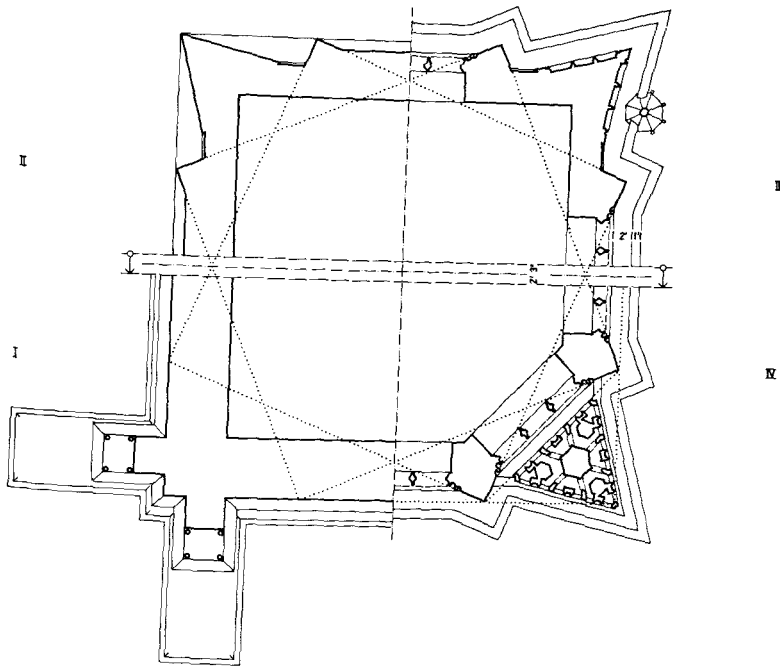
Freiburg Münsterturm, Grundriß Münsterturm, Grundrißschema des Vier- und des Achtorts.
